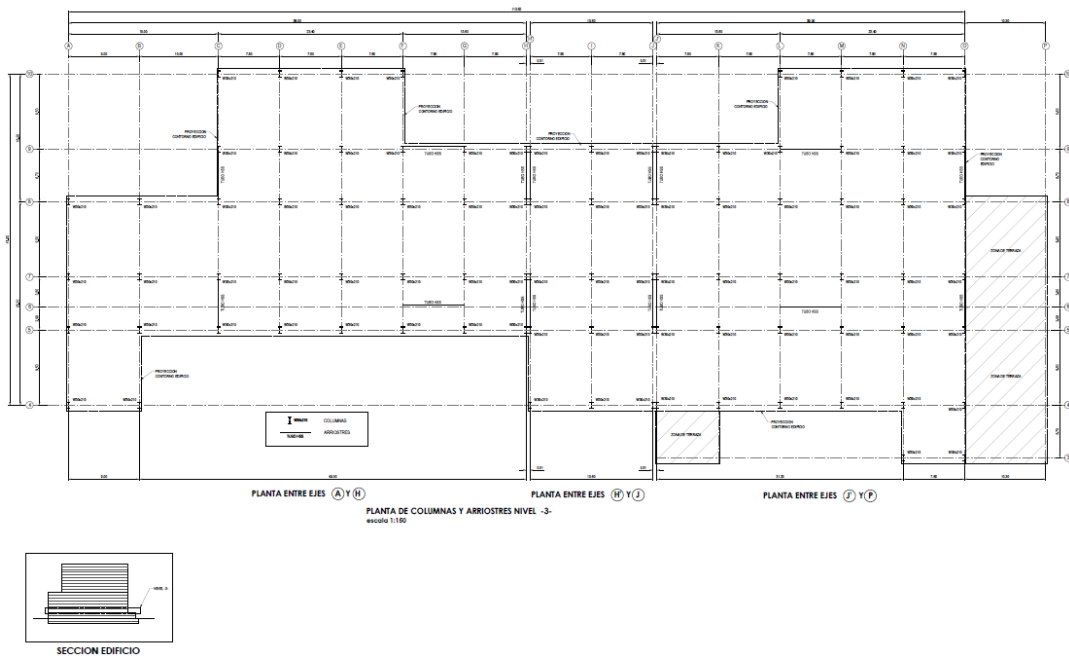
Planta Estructural Columnas, Muros y Arriostres. Nivel 3
